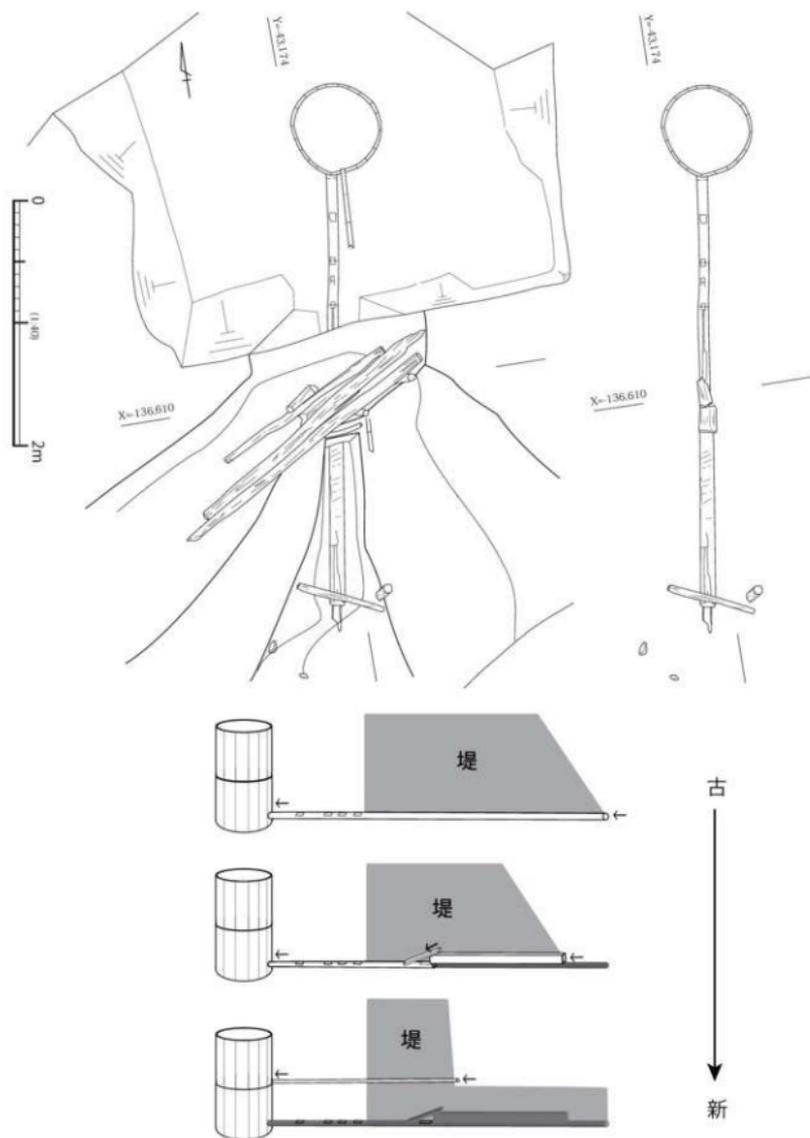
第7地区 第1面 22池 貯水施設 平面図 及び 断面模式図
